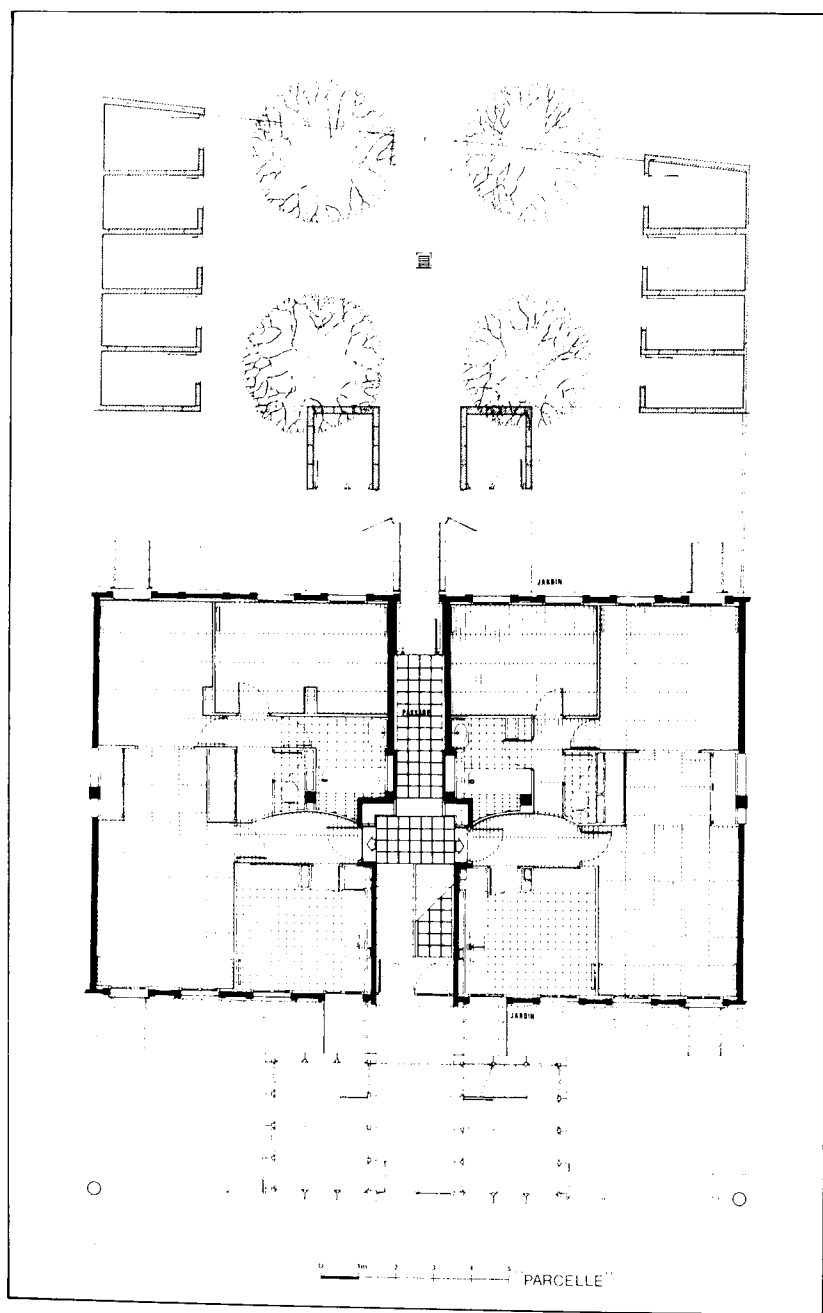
plan de constitution d'une "parcelle" ancrée autour d'une cage d'escalier.
